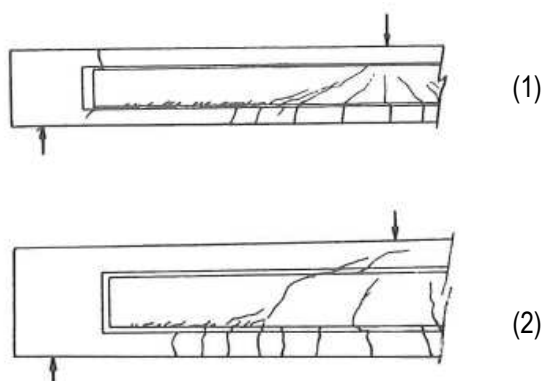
Fisuración en el alma que progresa hasta la zona inferior de tracción (Sozen)
